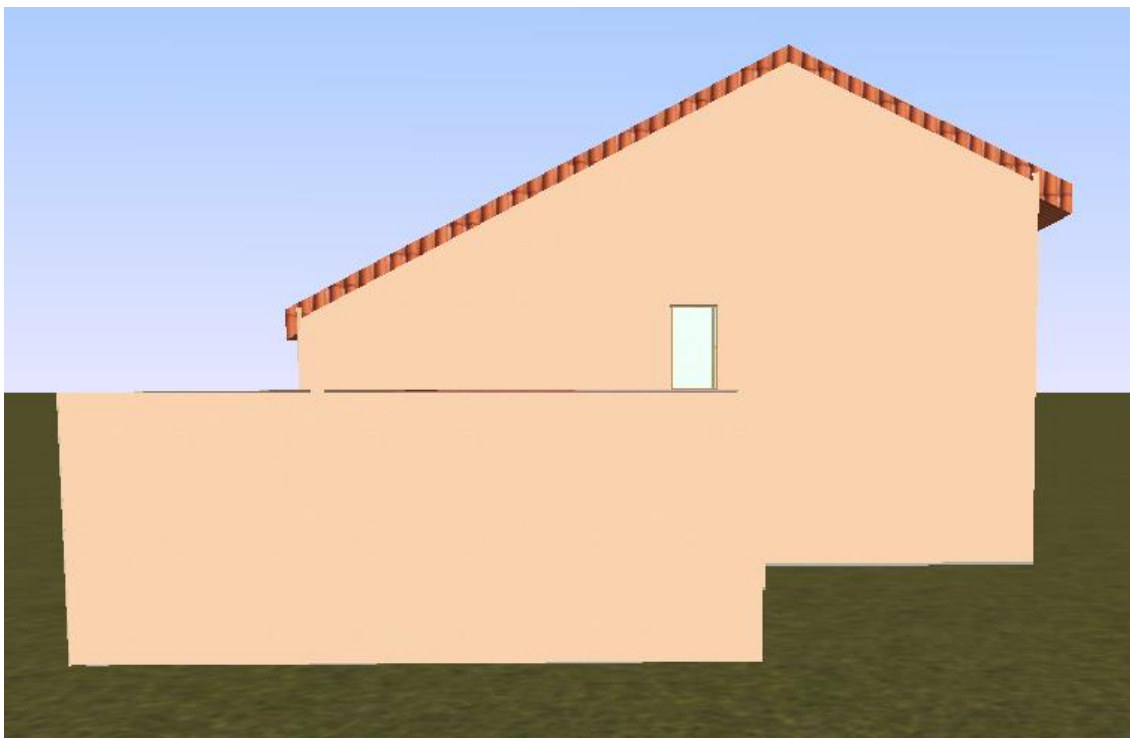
Alzado Norte vivienda con las mejoras implementadas.
